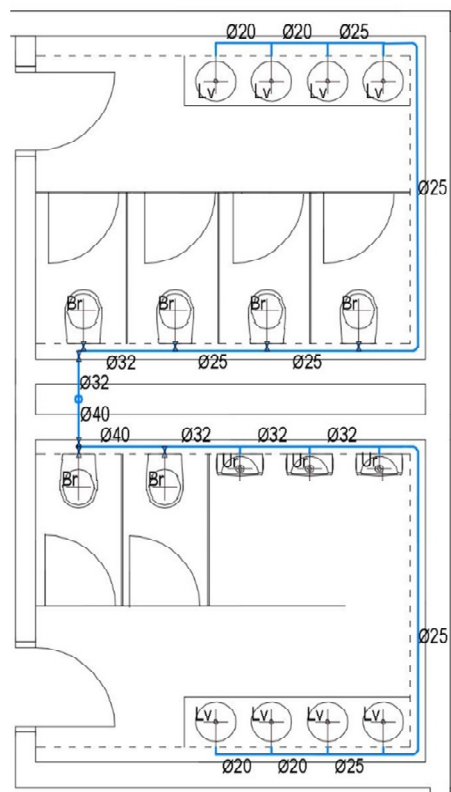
Planta da rede de abastecimento do 2º, 3º, 4º, 5º, 6º e 7º piso
